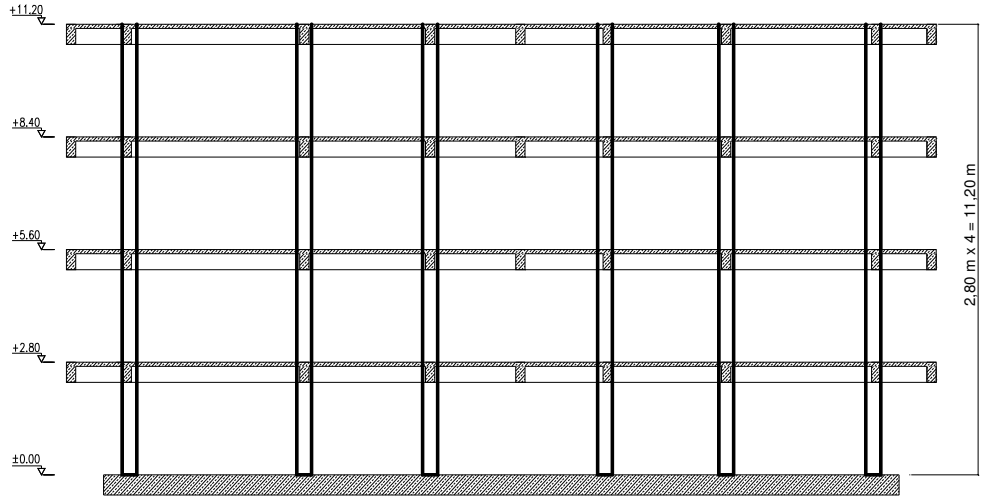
Örnek olarak seçilen plan simetrisine sahip olmayan dört katlı betonarme yapıya (BY2-8) ait kalıp planı
